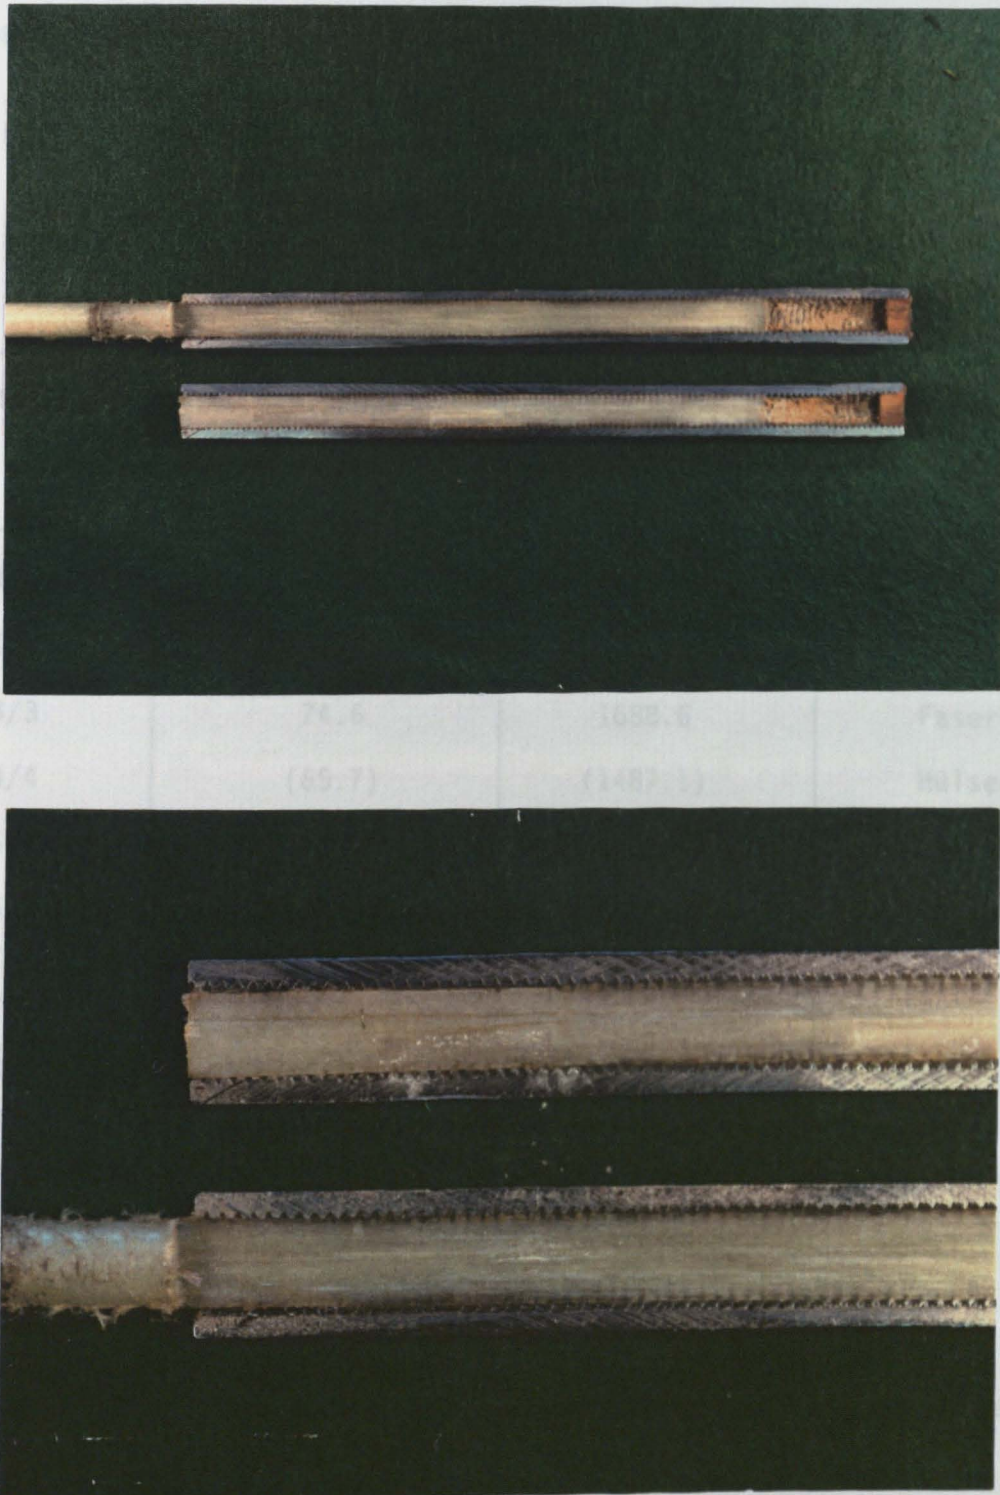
Längsschnitt durch eine Klemmhülse (150 mm) mit eingeklebtem Glas-FRW-Stab (Versagensart: Stabauszug)
